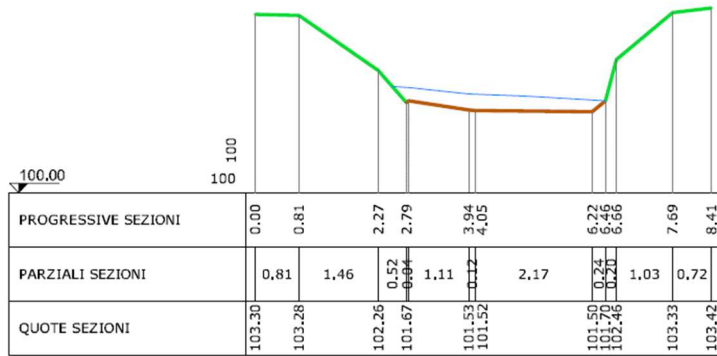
Sezione trasversale T1145 – 655 (sezione in corrispondenza della nuova passerella in oggetto)
